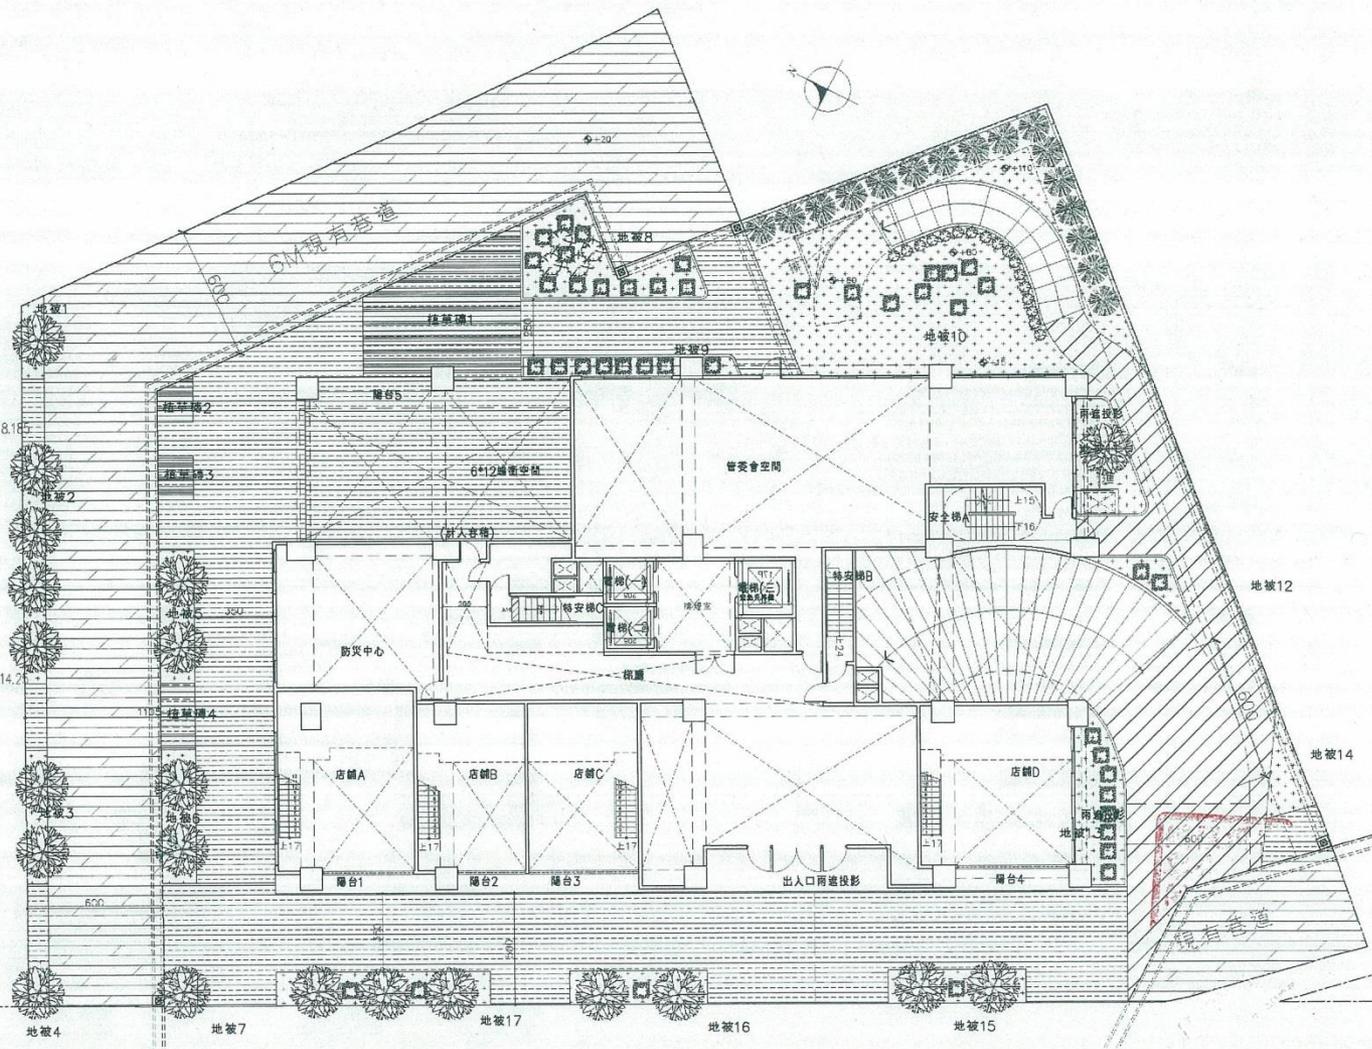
景觀配置平面圖、綠化植栽表、檢討表 S: 1/200
